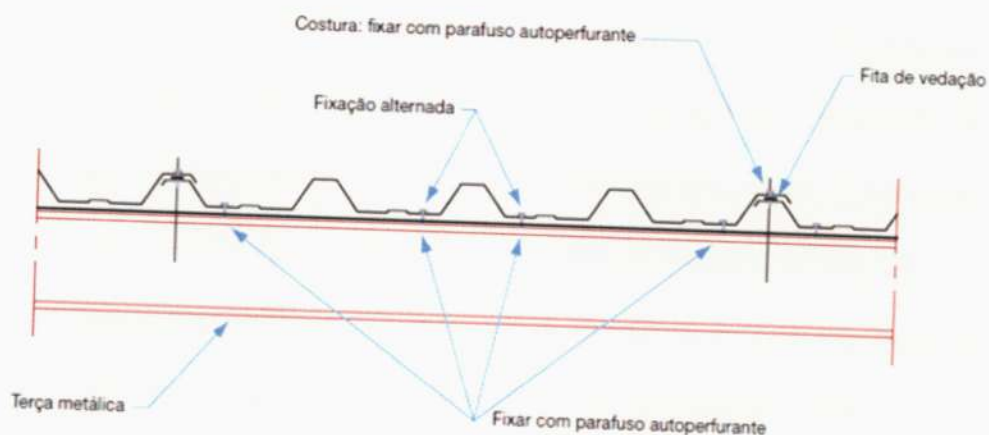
Montagem do telhado – telhas trapezoidais (Fonte: ABCEM, 2009)
